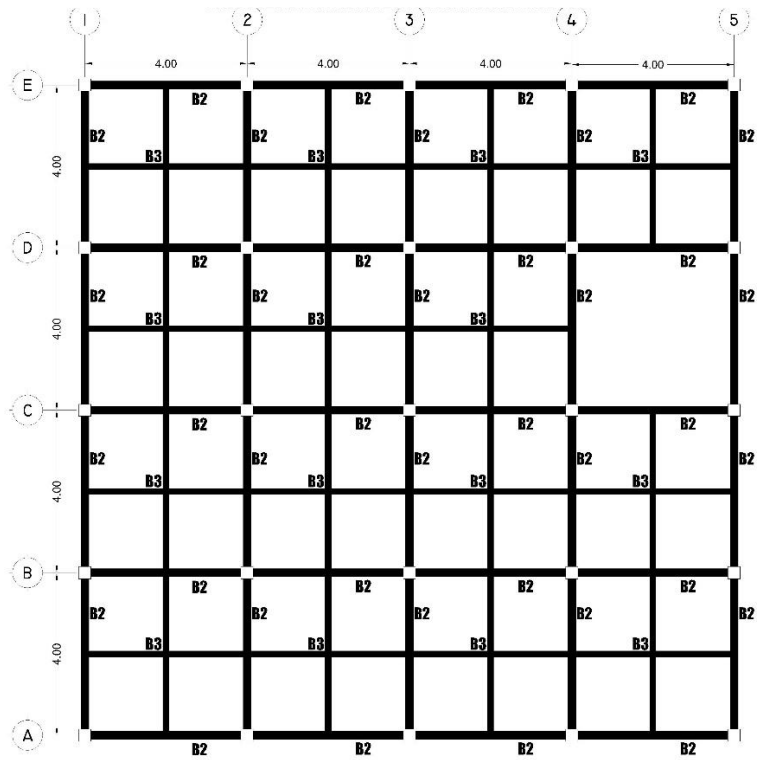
Denah Kolom Lantai 6 Sampai 10
